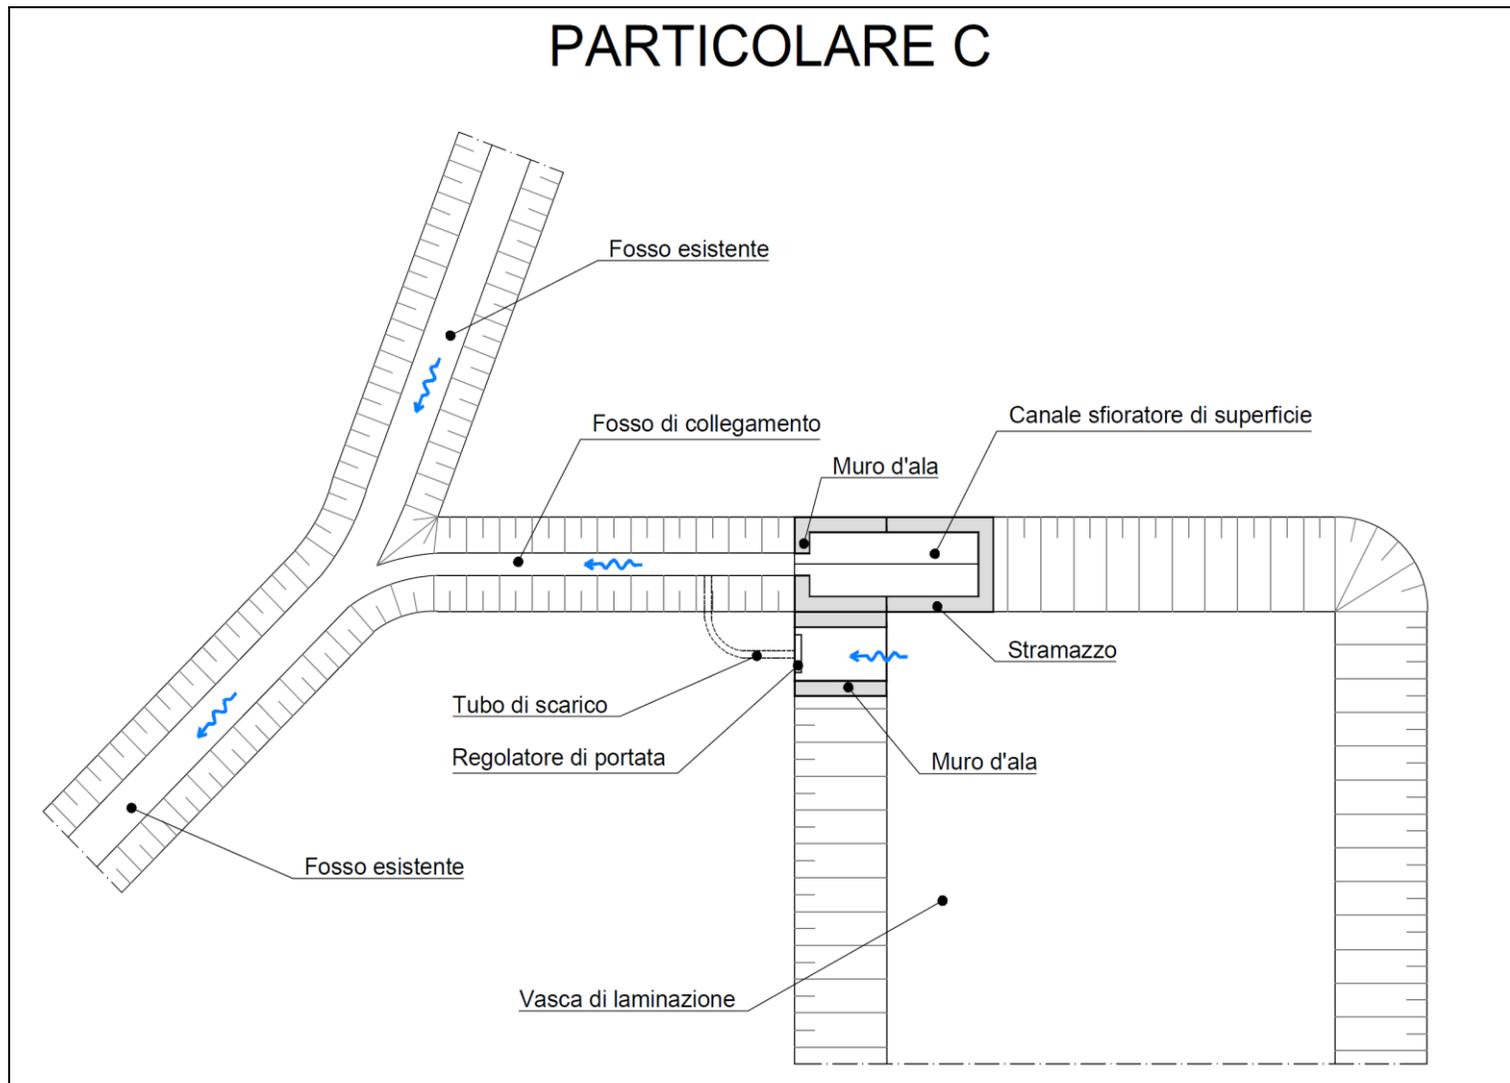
Planimetria di progetto del dispositivo di laminazione con dettaglio dello scarico (particolare C, riferimenti in Figura 18).
